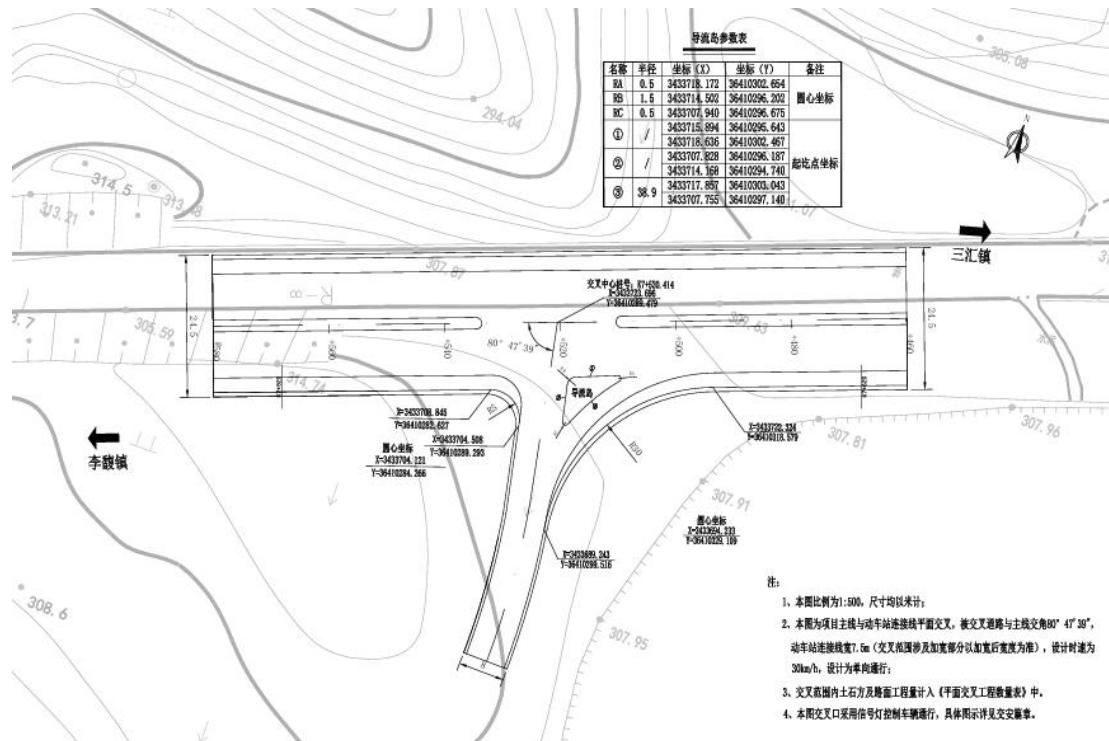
交叉工程平面示意图 (K7+520.414 段)
